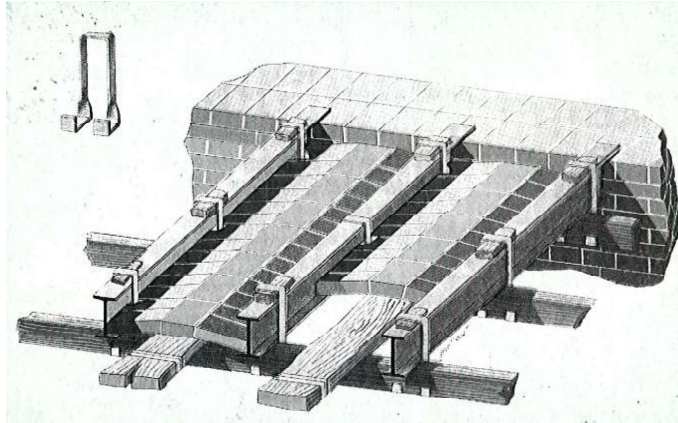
Plancher avec poutres à double T, bois et brique. D'après [46]
